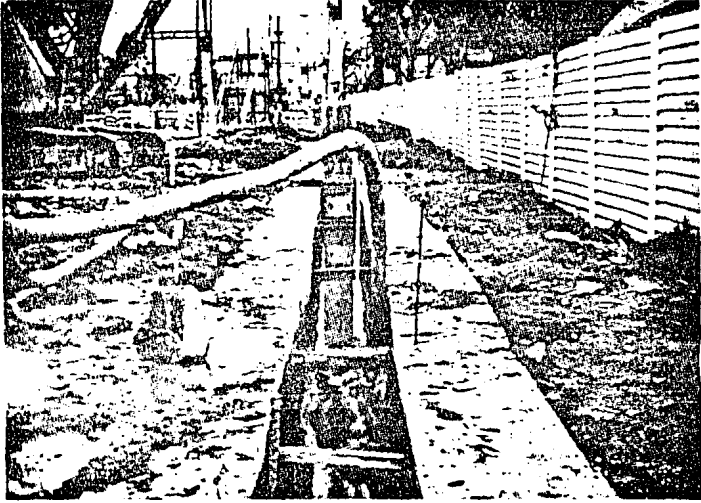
CONSTRUCCION DEL MURO MILAN
